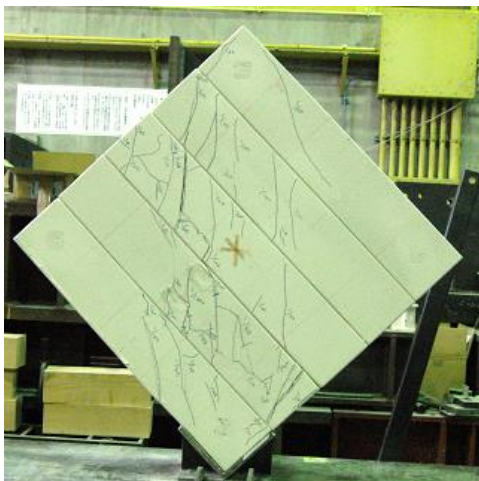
載荷後の試験体とひび割れ図
